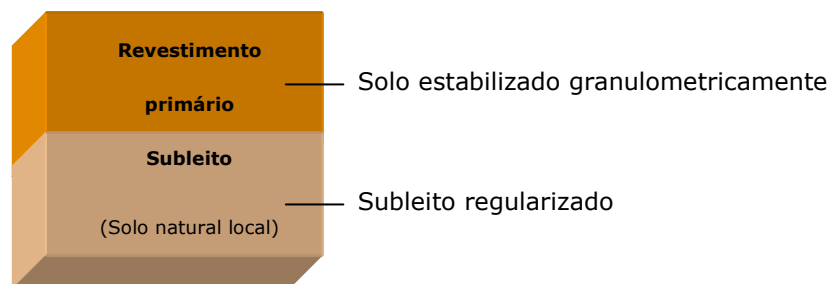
Modelo esquemático de pavimento de via com revestimento primário.
